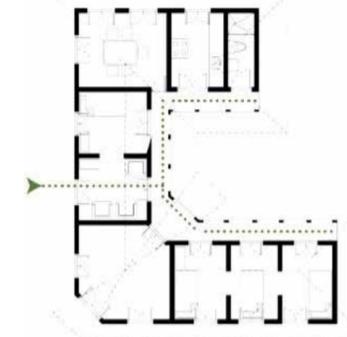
Fuente: Autor. Planta levantamiento arquitectónico vivienda cafetera tradicional. Tipología "U".
